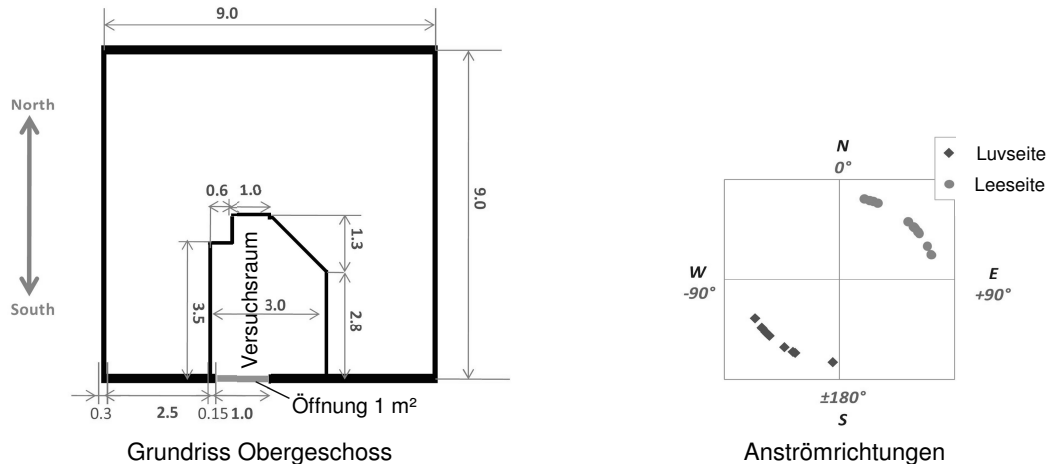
Grundriss des Obergeschosses mit dem Versuchsraum und den Anströmrichtungen des Experiments [nach 35, S.1766,1771]
